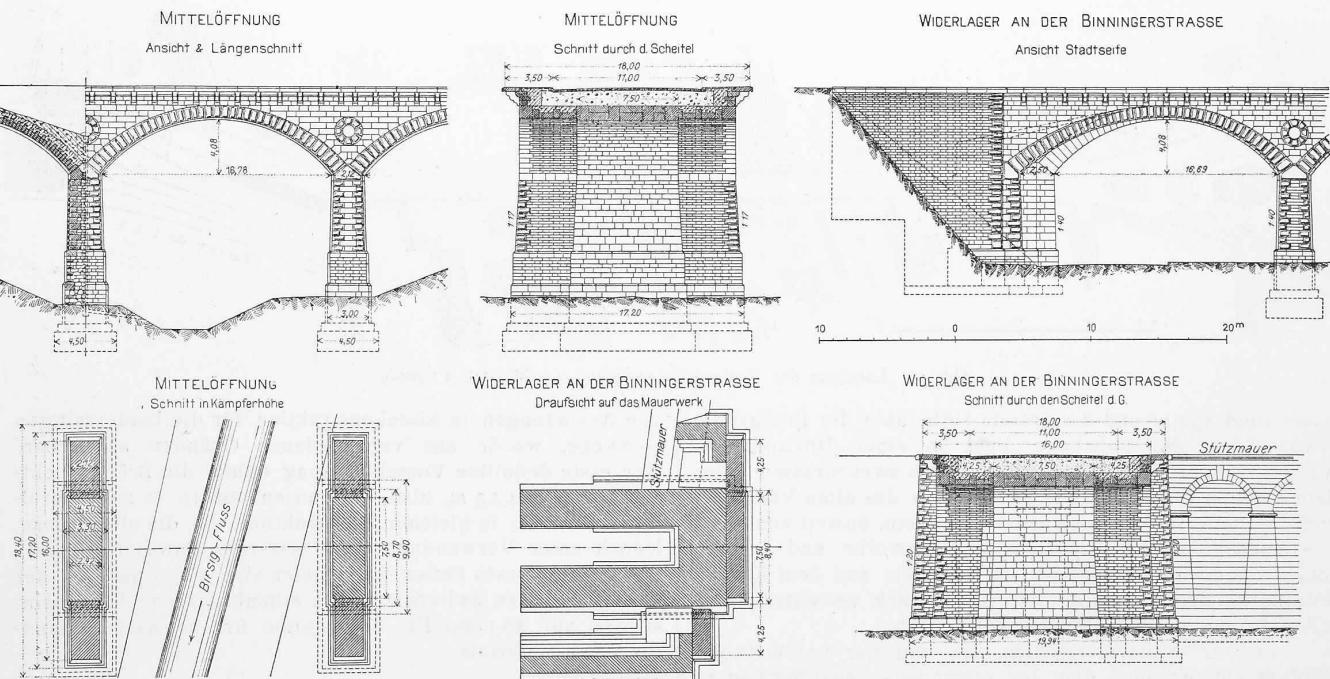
Grundrisse, Aufrisse, Ansichten und Schnitte des Ausführungsprojektes. — Details. — Masstab 1:500.
